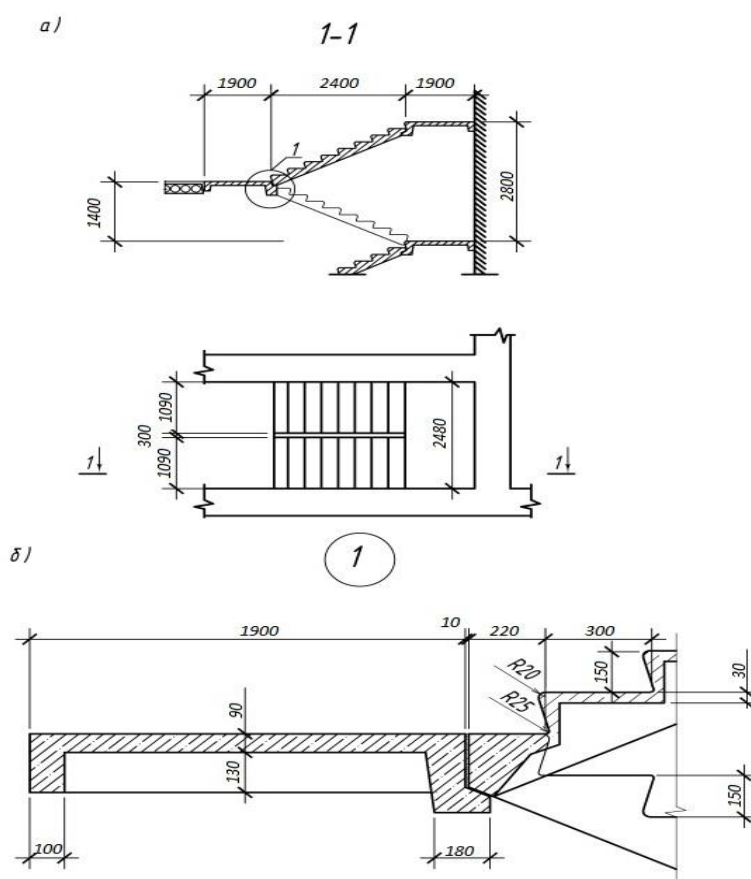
Детали сборной железобетонной двухмаршевой лестницы:
